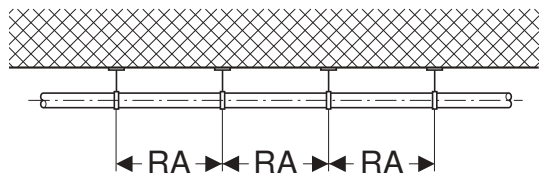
Espaçamento horizontal entre braçadeiras de tubos para tubos Geberit Mepla
